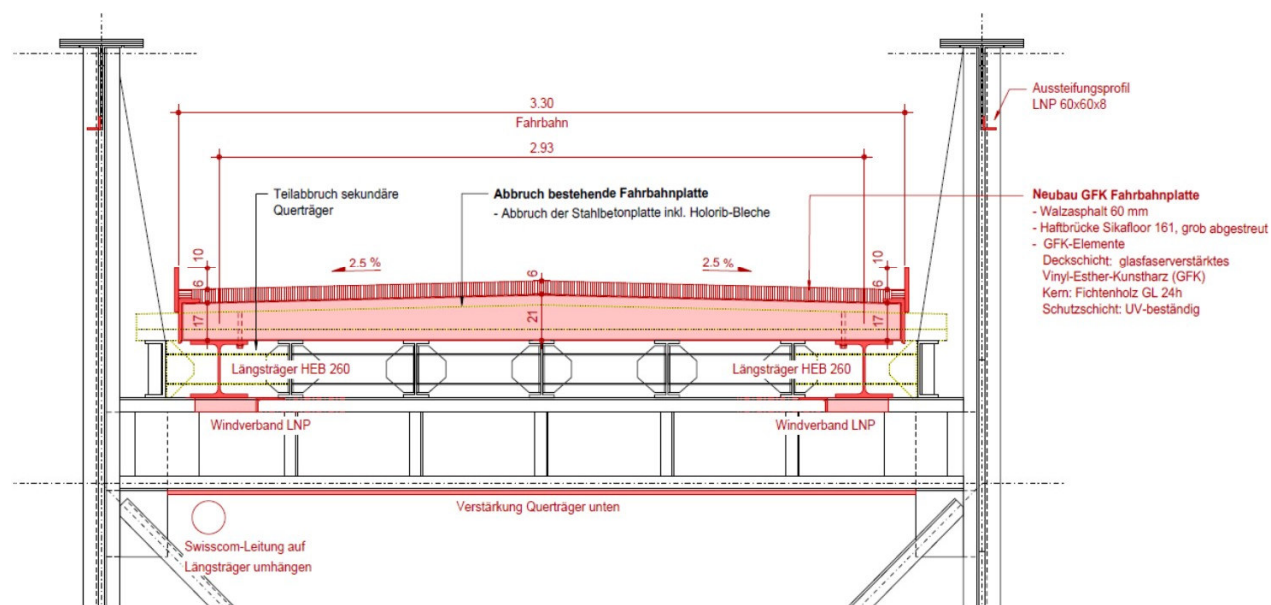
Querschnitt durch eine Stahlfachwerkbrücke mit dem Brückendeck der LeichtbauWeis AG
